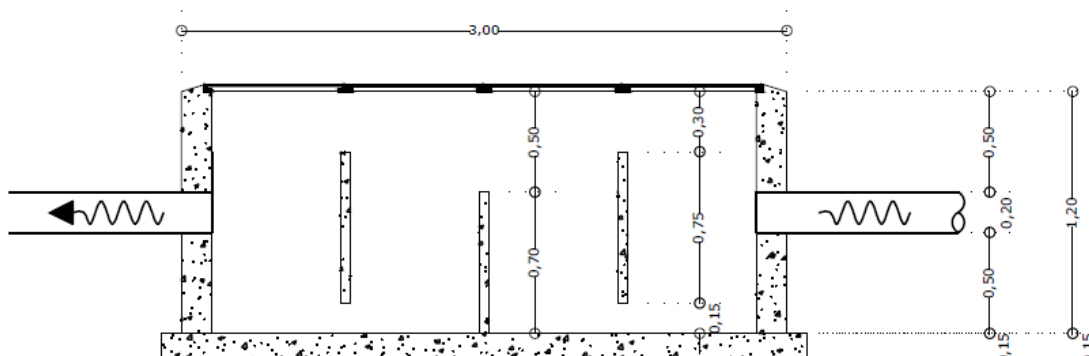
Dimensiones Cámara Desengrasadora. Vista en corte.
